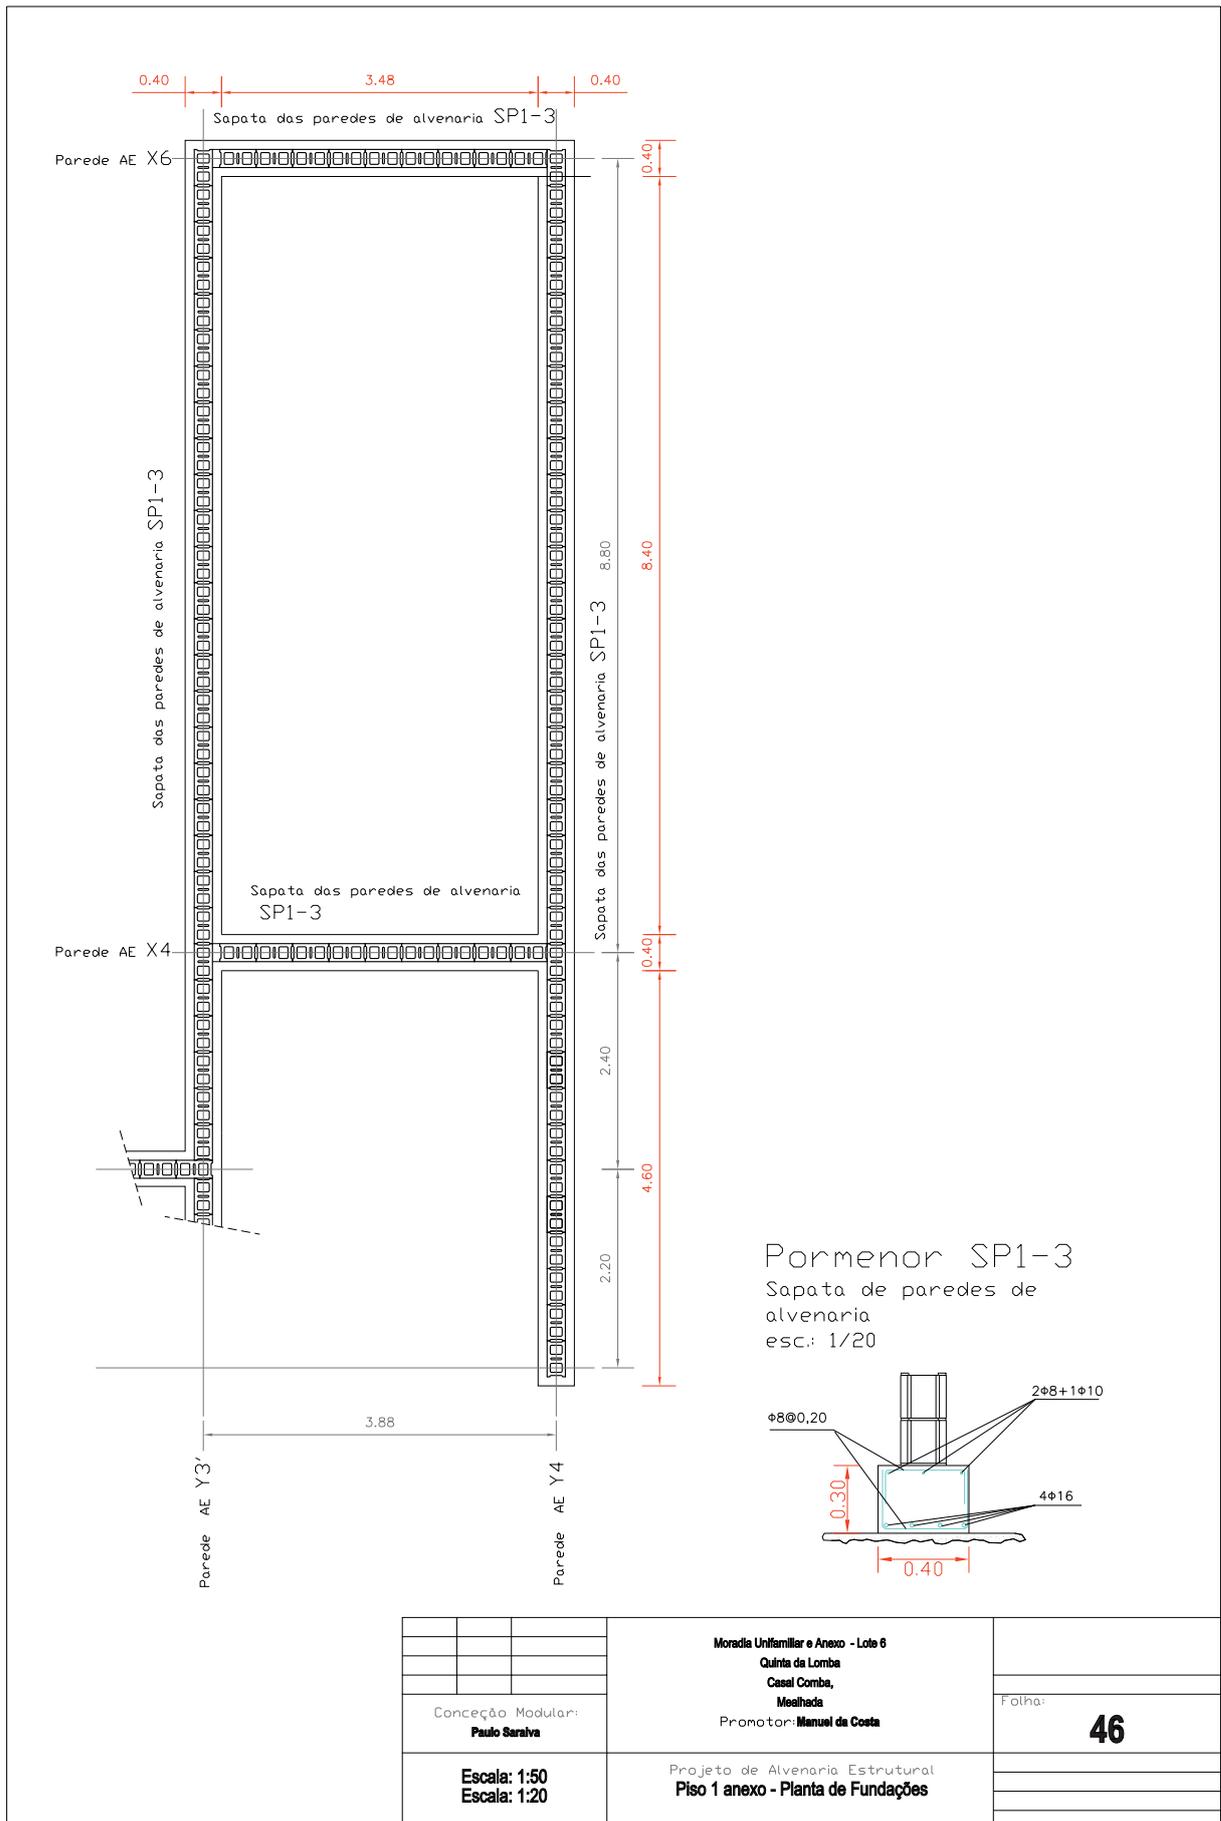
Plantas de fundações e 1ª fiada do anexo da solução em AE
